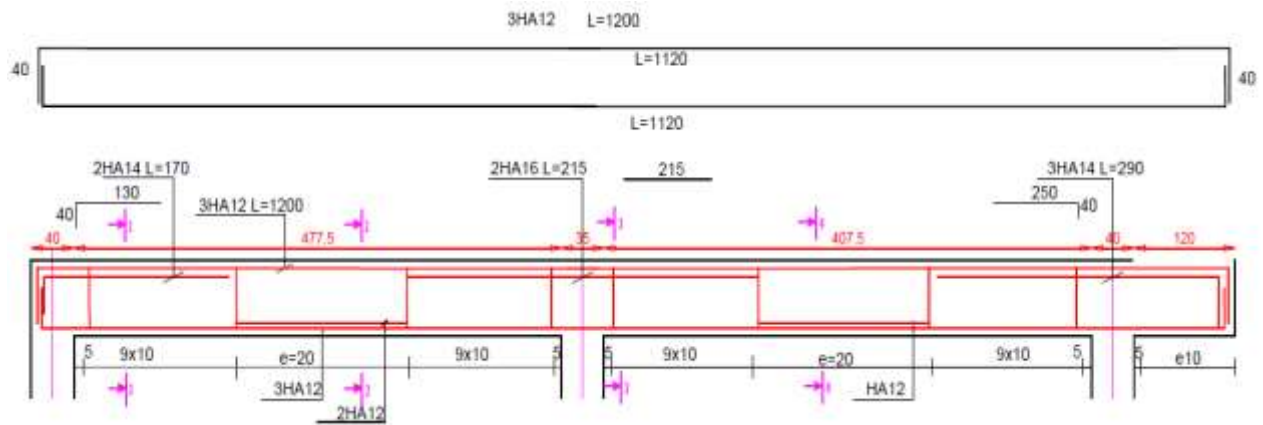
coupe longitudinale de la poutre principale (30x45)
